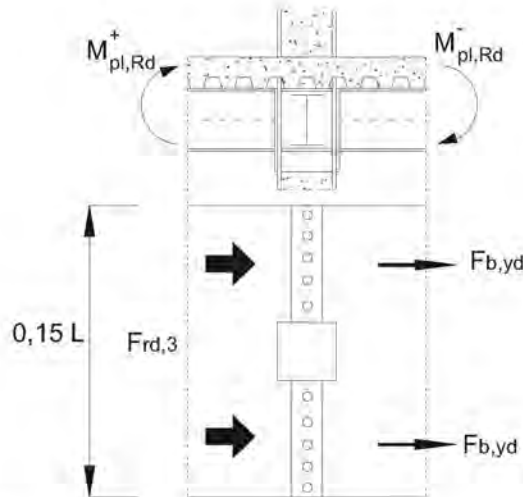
Meccanismo 3 – Connettori a taglio sulle travi secondarie
